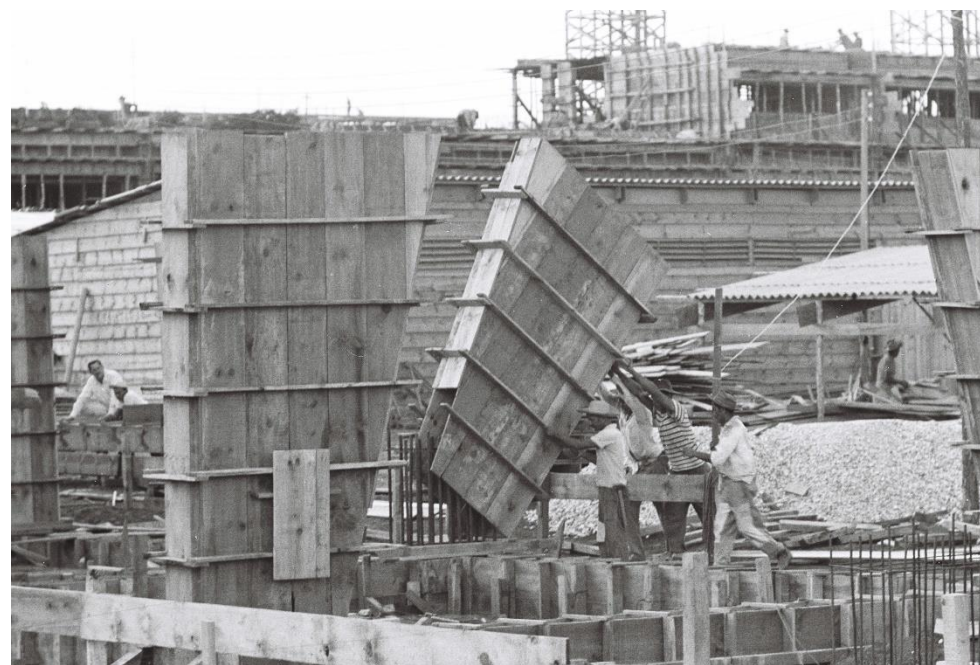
Construção dos pilares trapezoidais. Fonte: Arquivo Público do DF.
